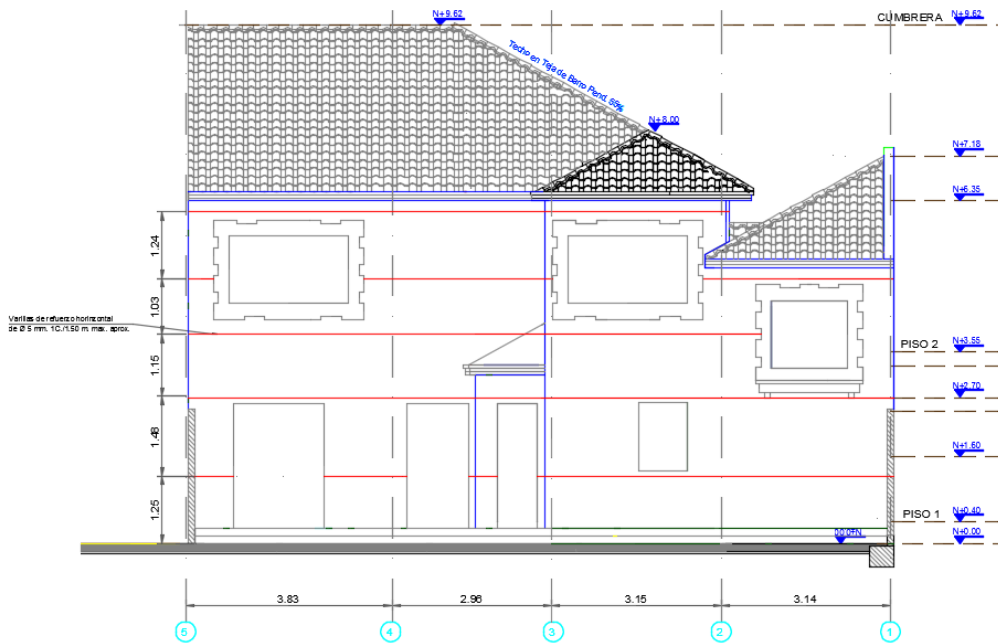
Distribución de las varillas de acero en la fachada posterior de la casa ubicada en la carrera 18 # 34-15. Fuente: Planos de reforzamiento elaborados por el Ing. Manuel Antonio Ramirez Vargas
